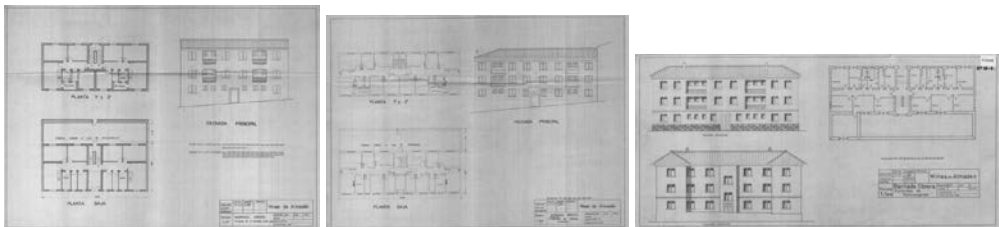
Planos bloques de viviendas, tipo C, D y E, anteproyecto (1969)
